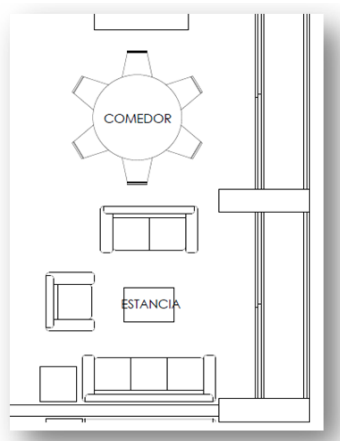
Planta arquitectónica del nivel 2 al 12, Grupo Une, (2017).
